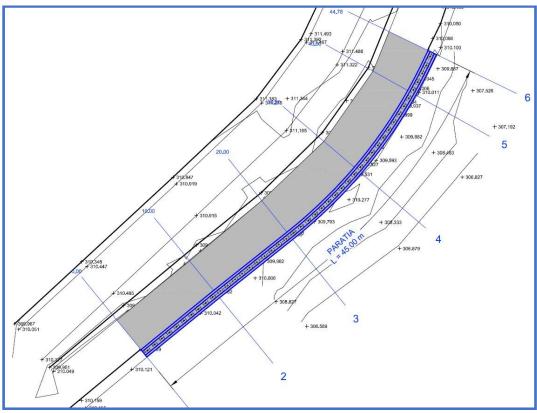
Zona intervento 1 – Planimetria dell'intervento
